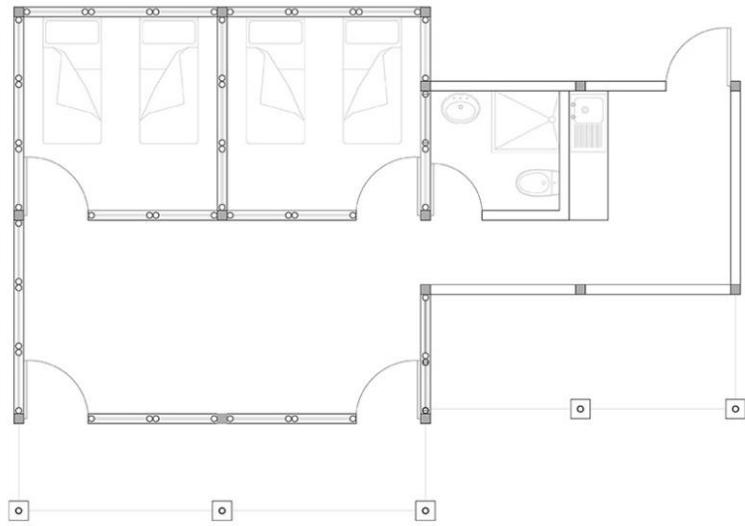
fuente Plataforma Arquitectura, Planta Arquitectónica
